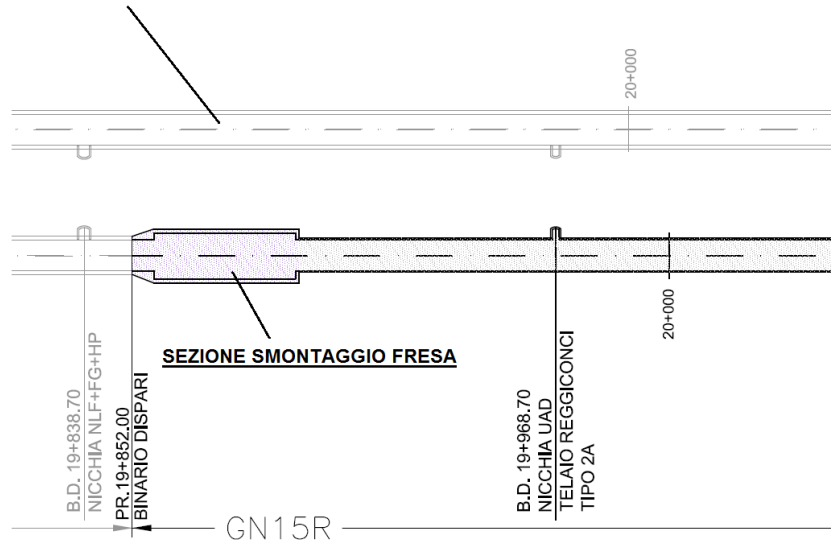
Dettaglio planimetrico sezione smontaggio fresa binario dispari (WBS GN15R)
